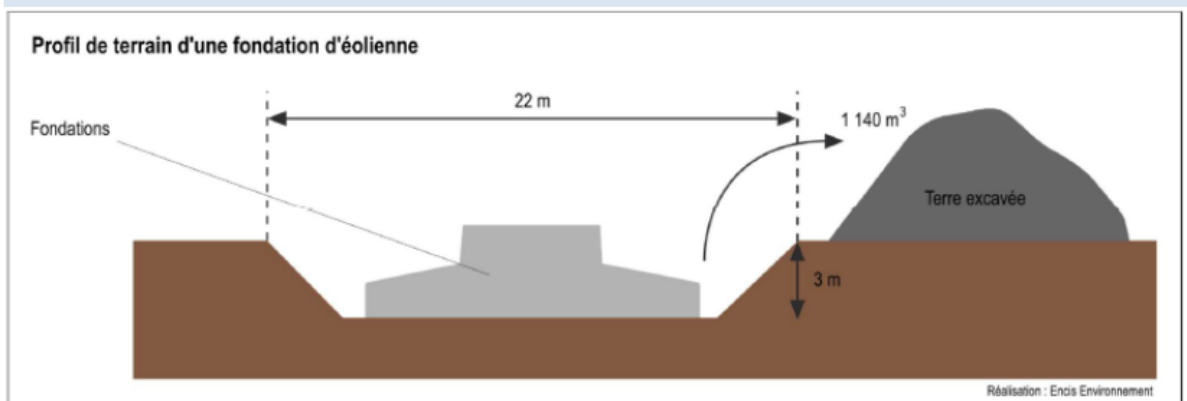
Profil de terrain d'une fondation d'éolienne.
